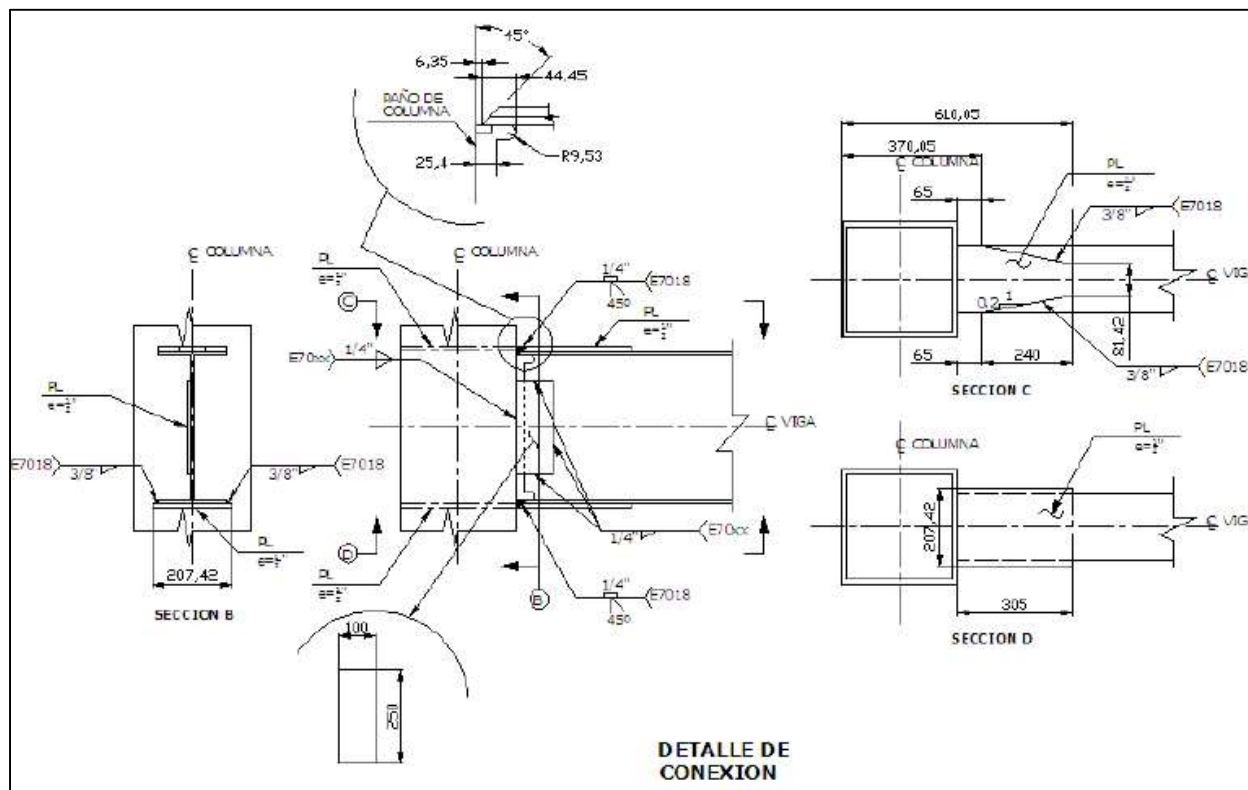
Especimen de conexión soldada directamente con atiesadores internos como refuerzo.
